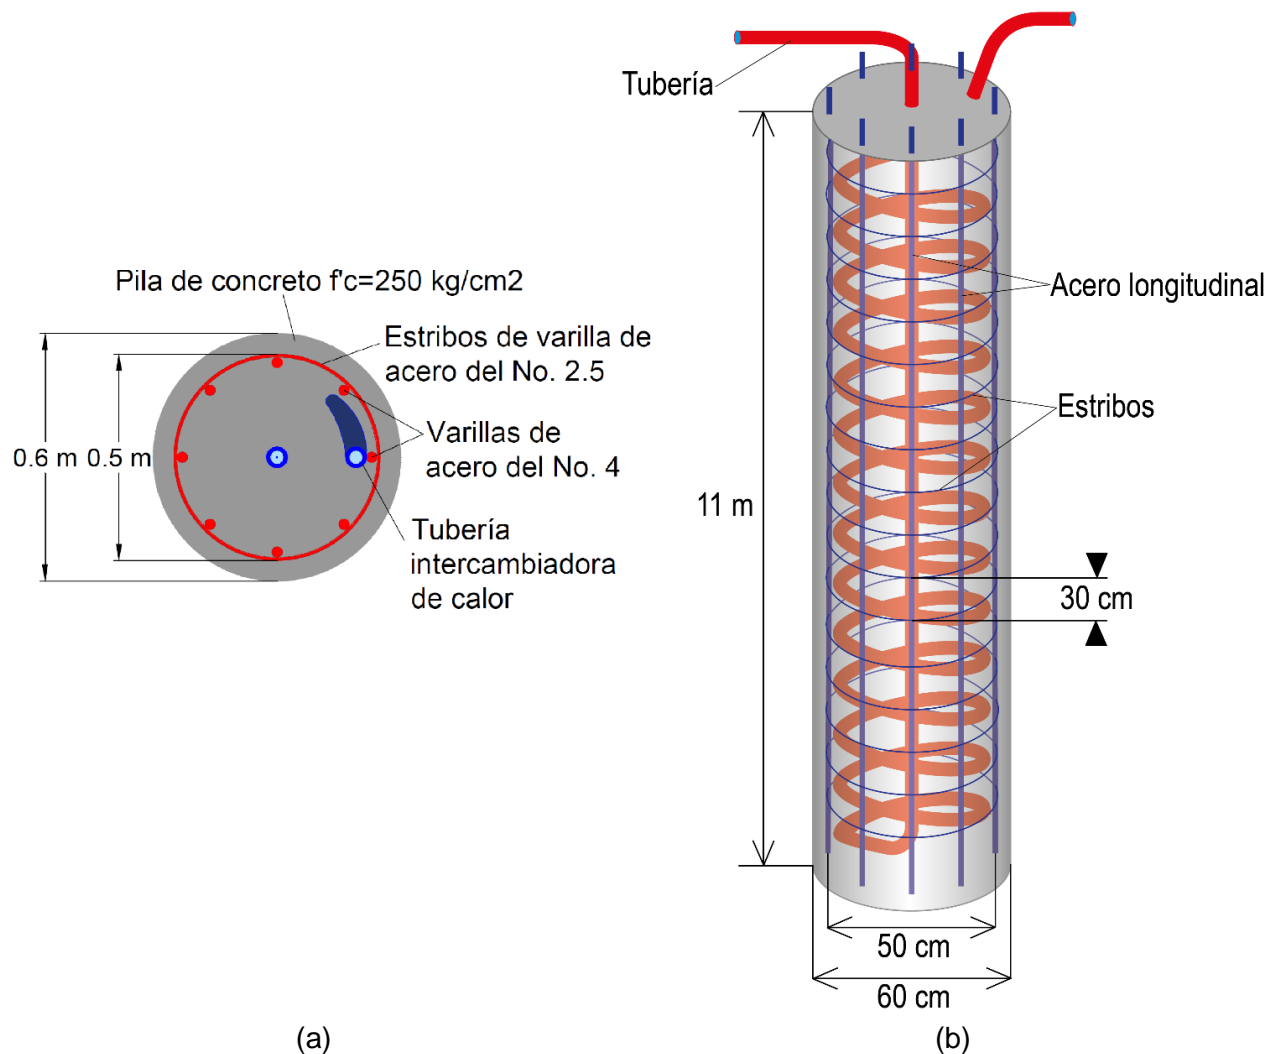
Esquema de la pila de energía con tubería helicoidal: (a) Sección transversal; (b) Sección longitudinal
